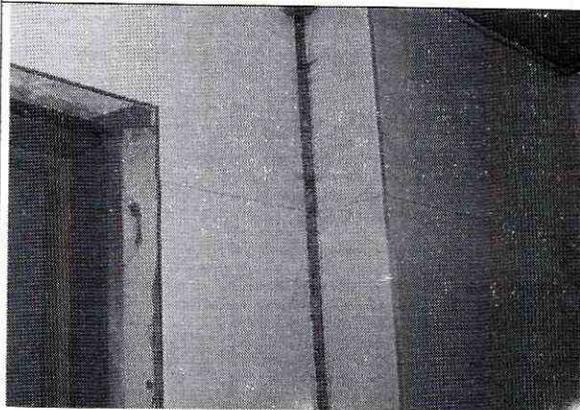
Daños en muros del segundo piso, costado sur occidental.
